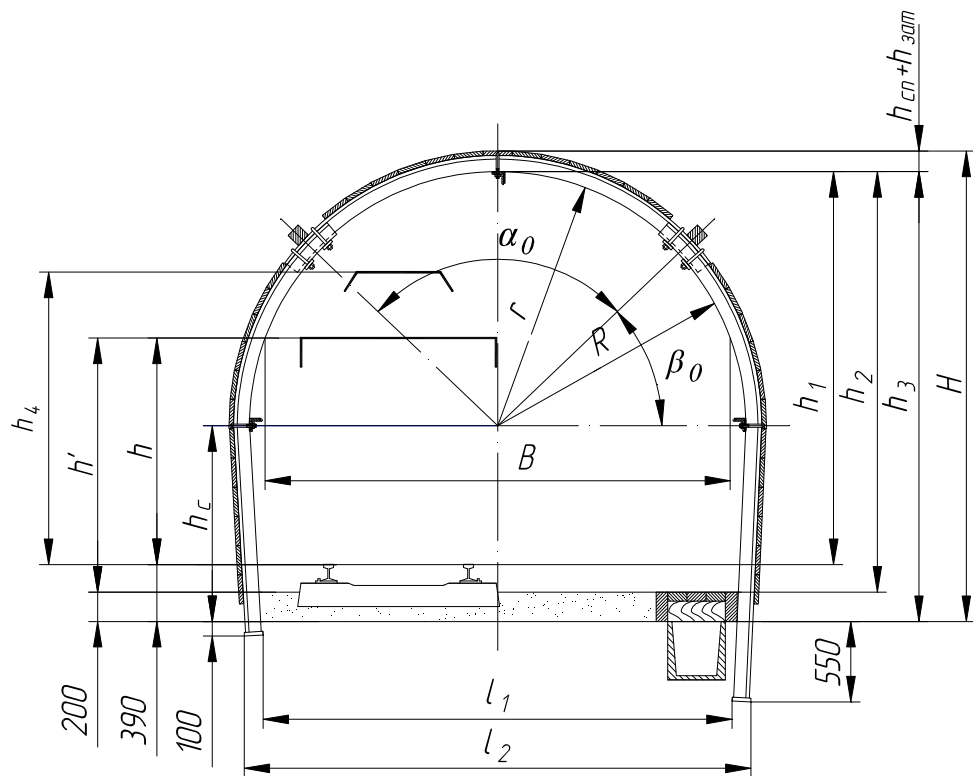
Расчетные схемы для выработок с анкерной крепью:
